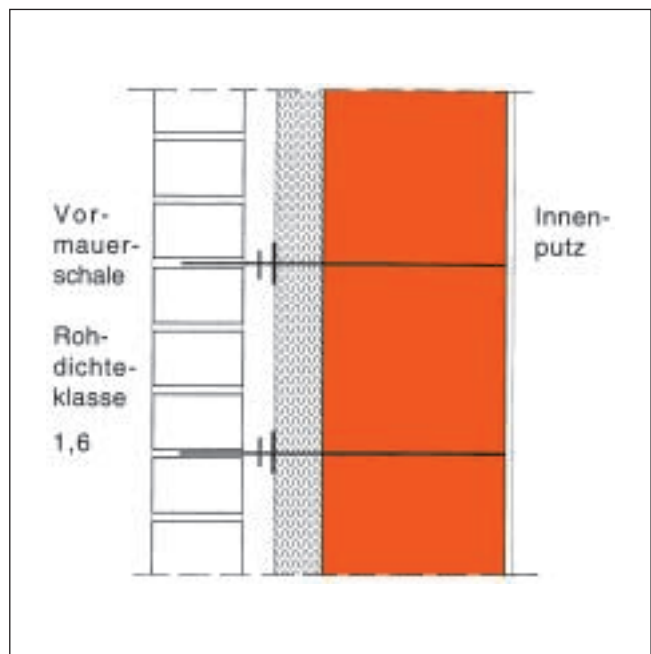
Schnitt durch zweischaliges PlanZiegel-Mauerwerk mit Luftschicht und Dämmschicht, verbunden mit V4A-Flachanker
